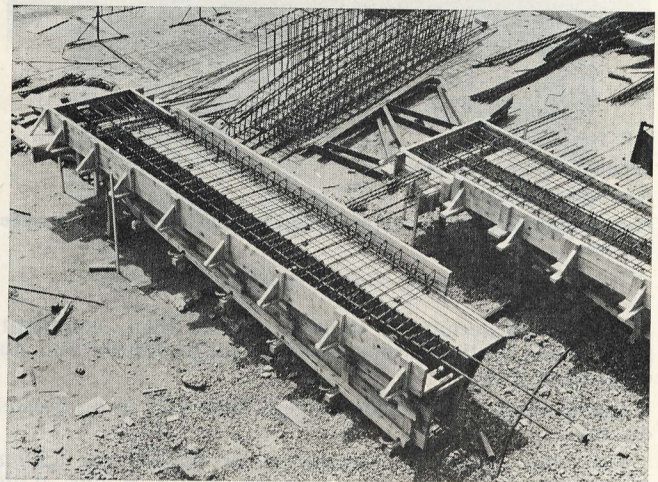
Une console au sortir de l'atelier prête à la mise en place avec tout son ferrailage, ses cônes d'ancrage, les attentes et la gaine de la poutre de rive; les attentes de dalle sur la console de droite.
